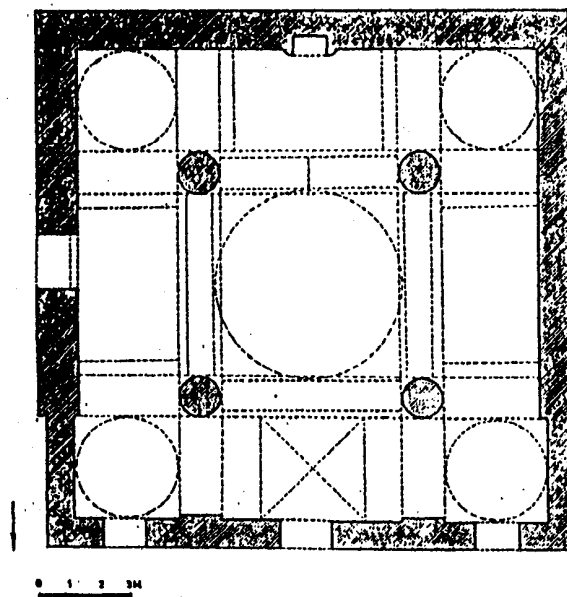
مسقط أفقي لجامع السلطان بايزيد في استانبول
